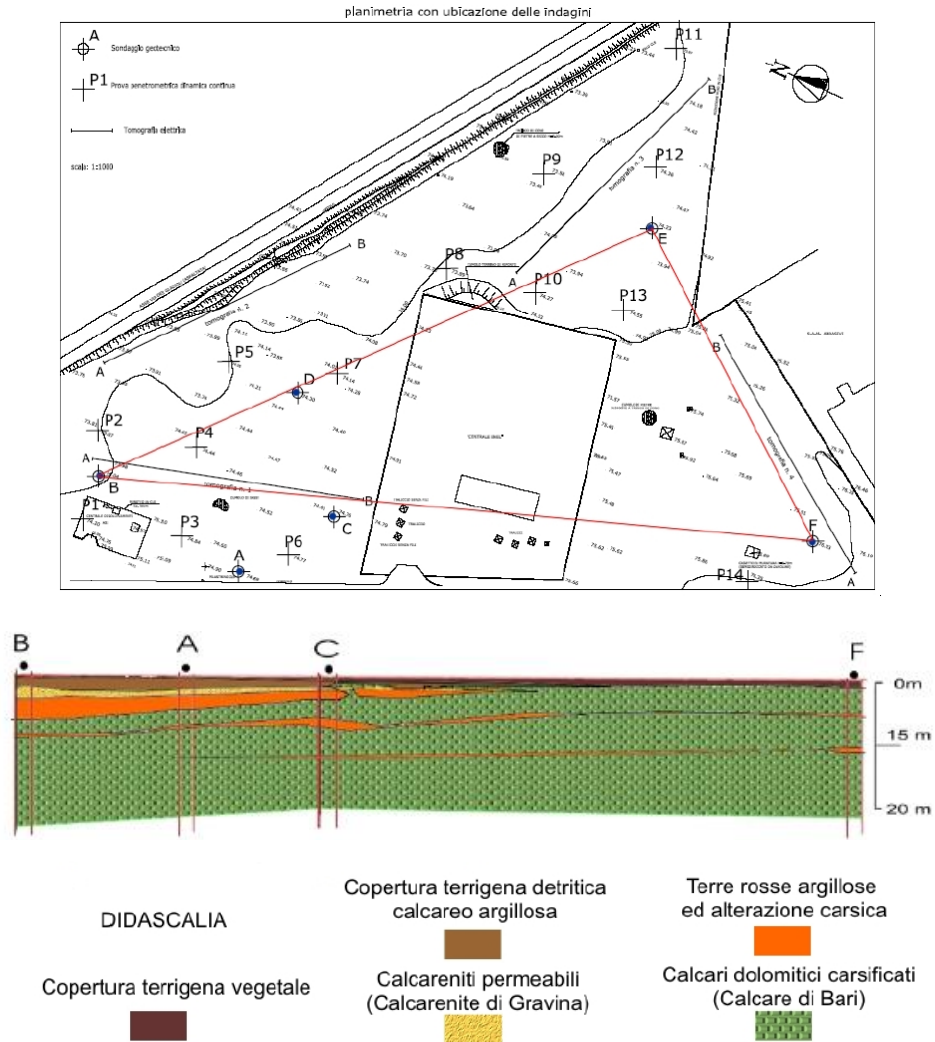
Planimetria con ubicazione delle indagini e sezione stratigrafica
